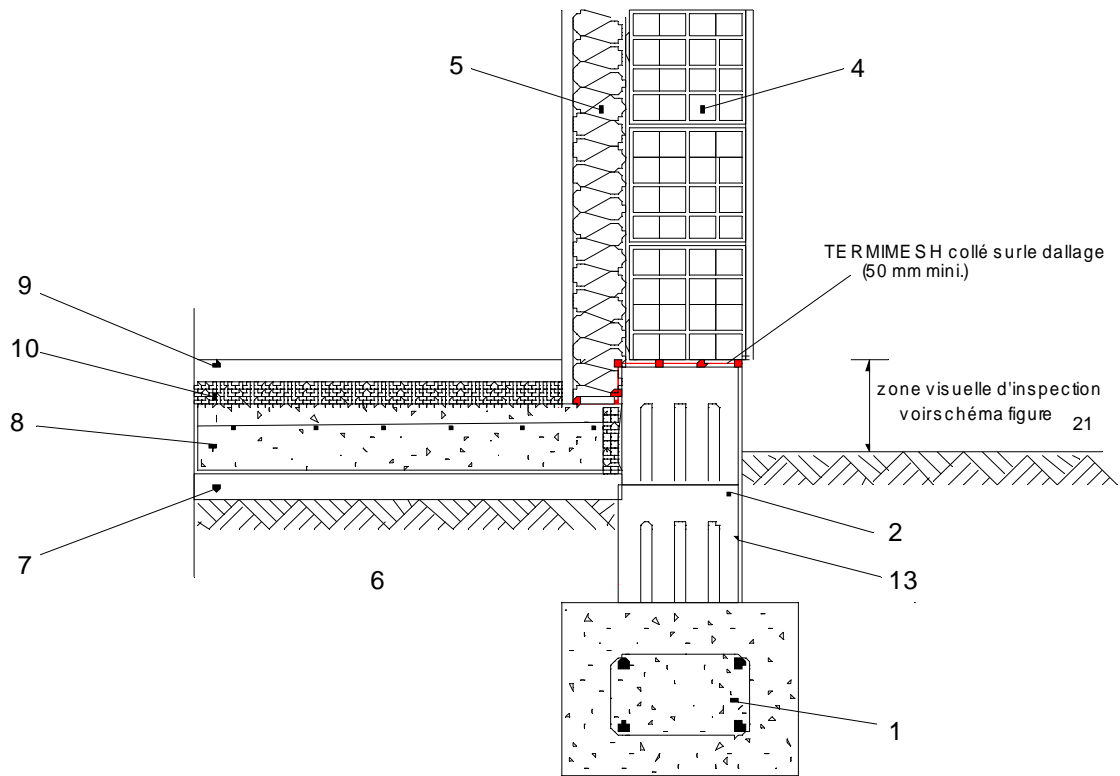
EU 1.2-2 : dallage désolidarisé avec bande résiliente pour construction sur soubassement en blocs maçonnés
